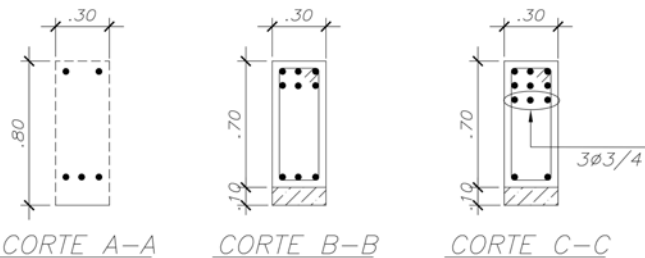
Diseño Final de La Viga de Cimentación VC C 4-5
